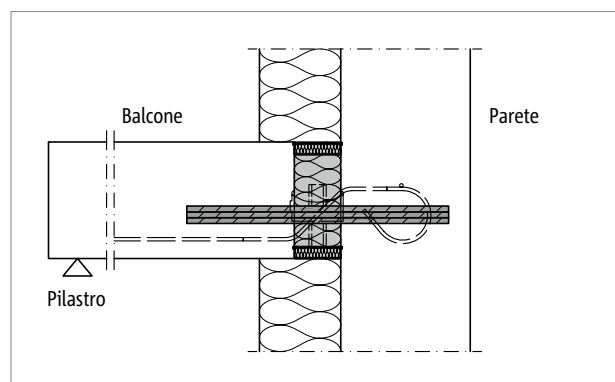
Schöck Isokorb® T tipo QL, HP-VV-NN: raccordo di una parete in calcestruzzo armato con isolamento esterno
